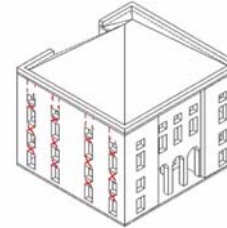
Schadenstyp P6: Schubversagen der Aussenwände – Horizontale Elemente
